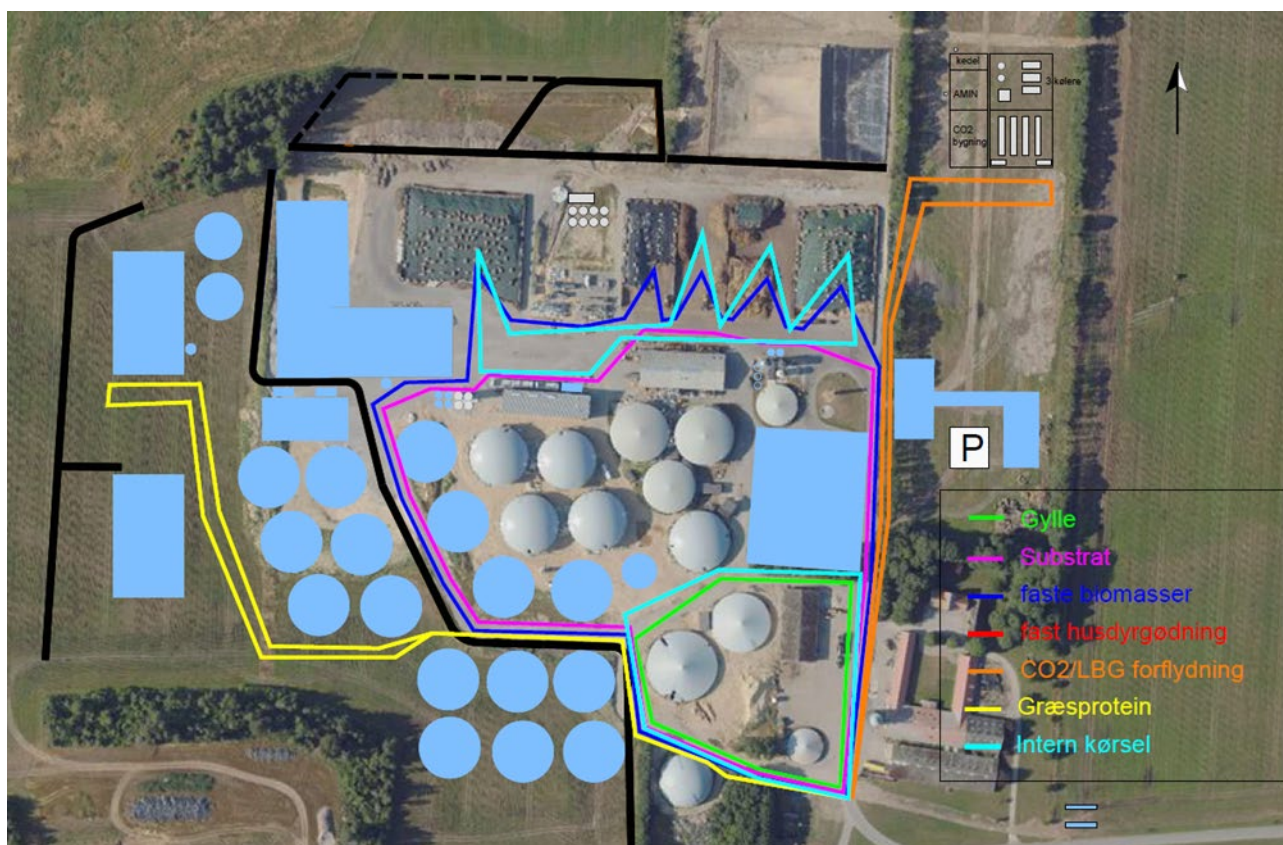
Situationsplan for Sindal Biogas med stationære støjkilder.
